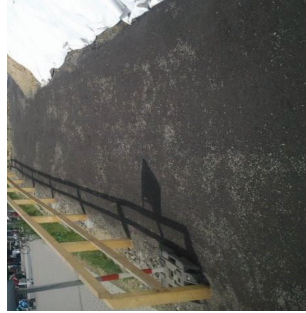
Zakrytí úchytů a prostupů betonových panelů (například, provizorní zastávky ND/NAD)
